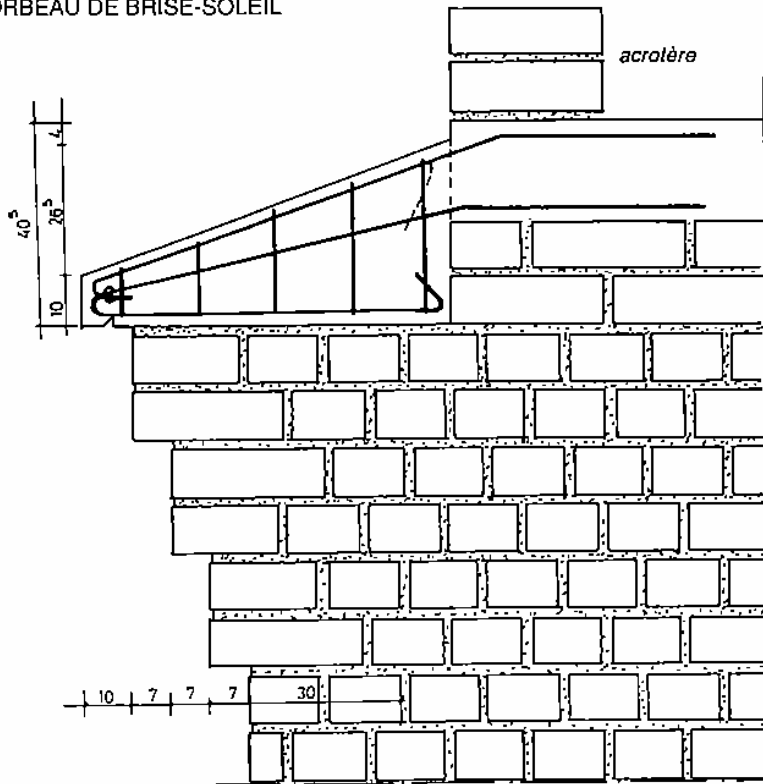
Encorbellement de façade et son corbeau en B.A. pour fixation des brise-soleil.
